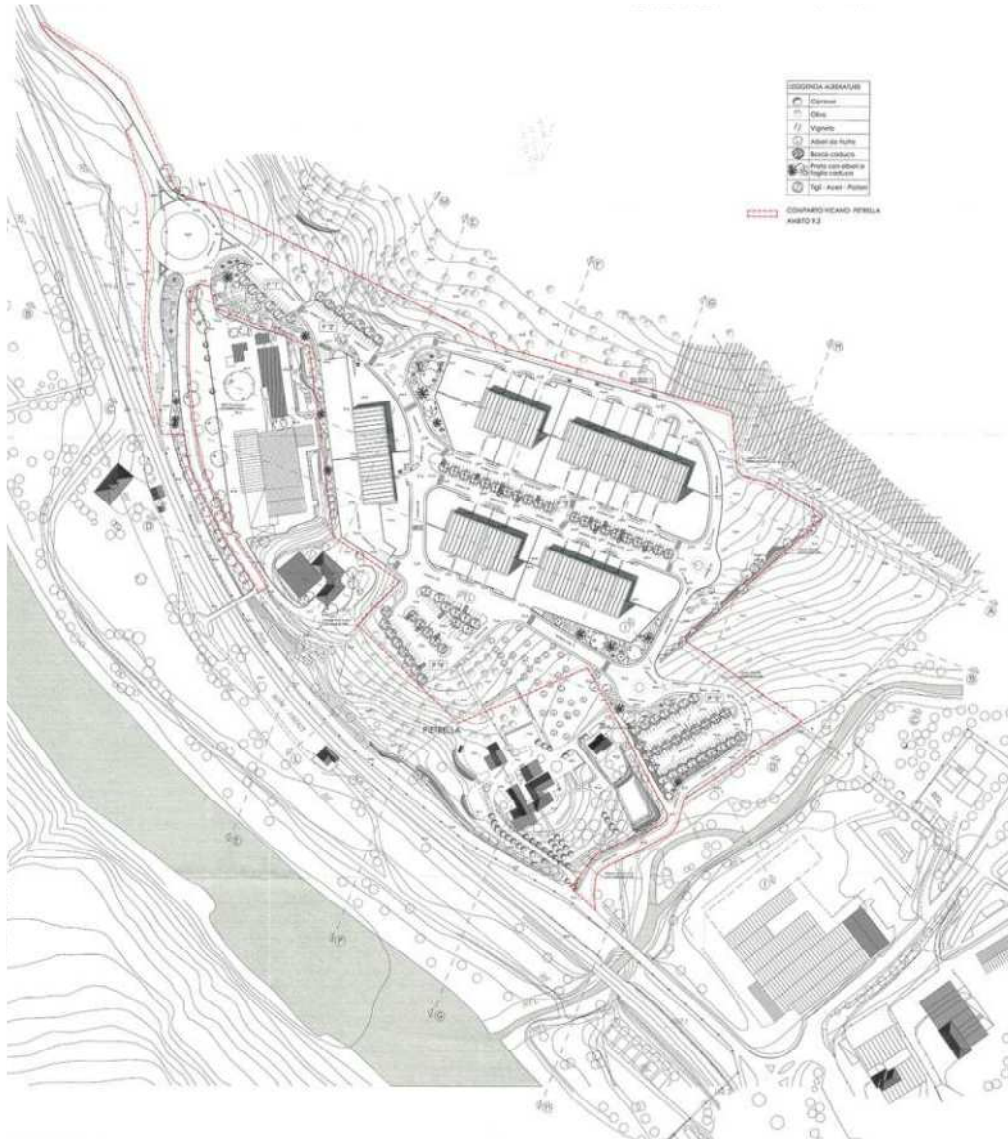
Estratto Tav. n. 7 – planivolumetrico PUC vigente
